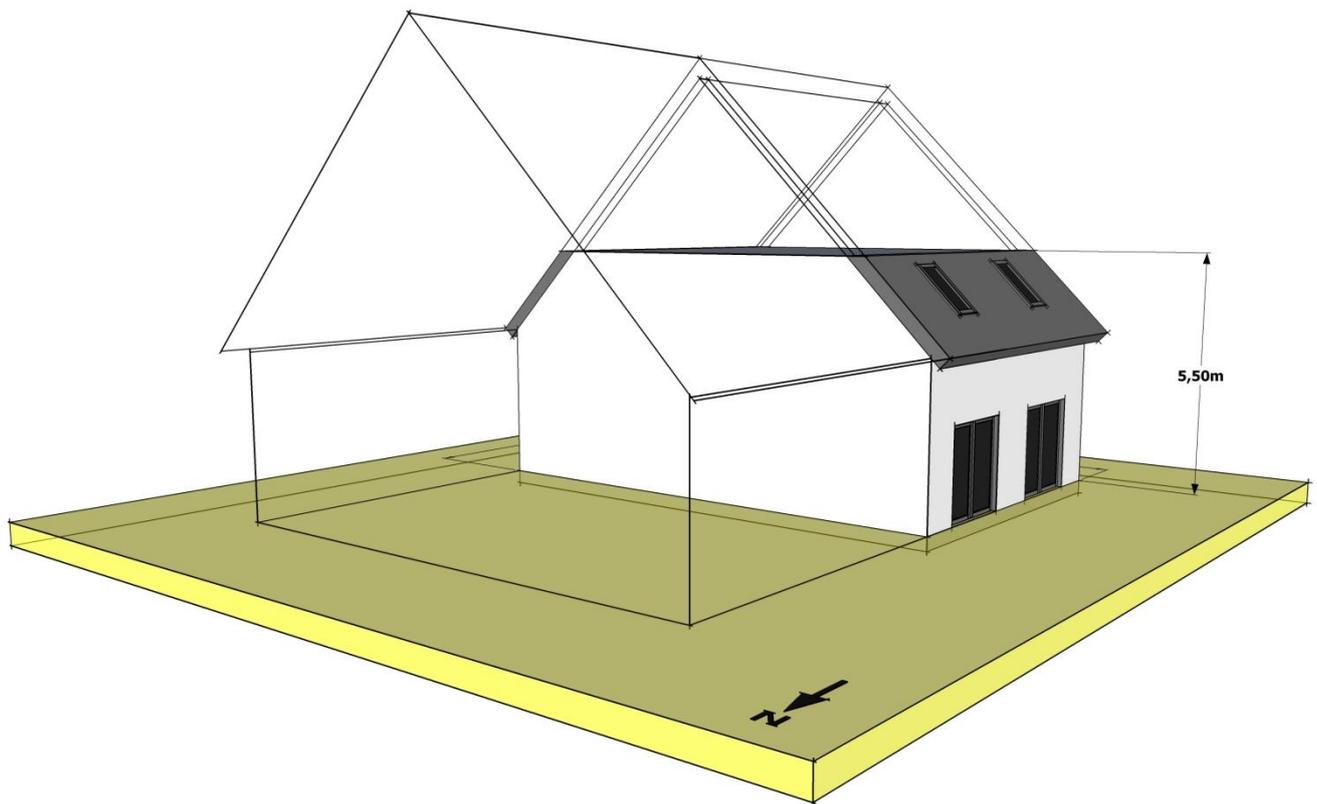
Doppelhaushälfte Süd – Ansicht Nord-West
